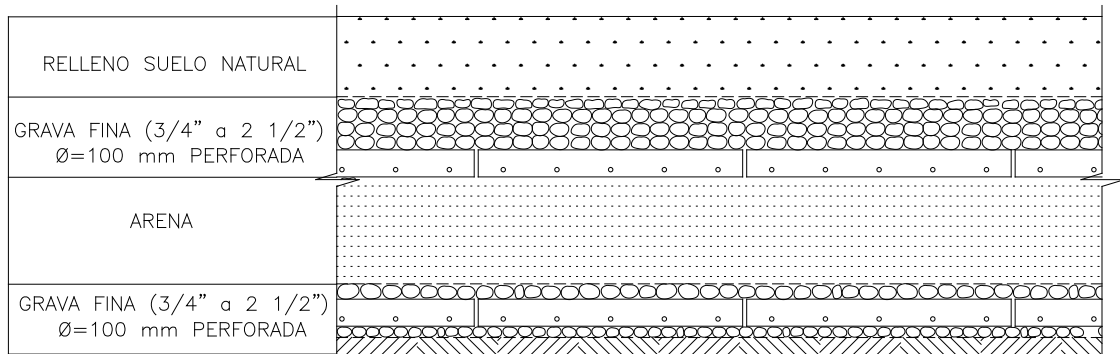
Corte Longitudinal del Lecho de Infiltración
